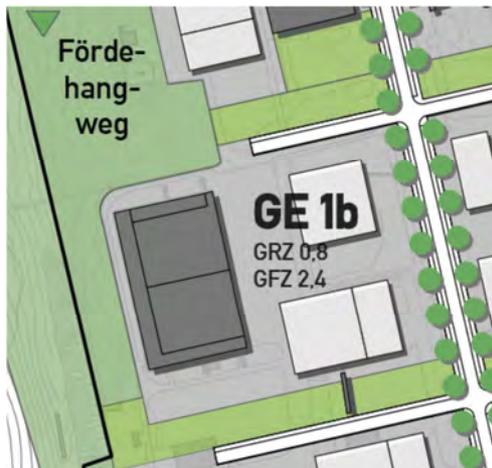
Ausschnitt aus dem Lageplan, Gewerbe Nord, beispielhafte Darstellung des Maßes der städtebaulichen Nutzung
